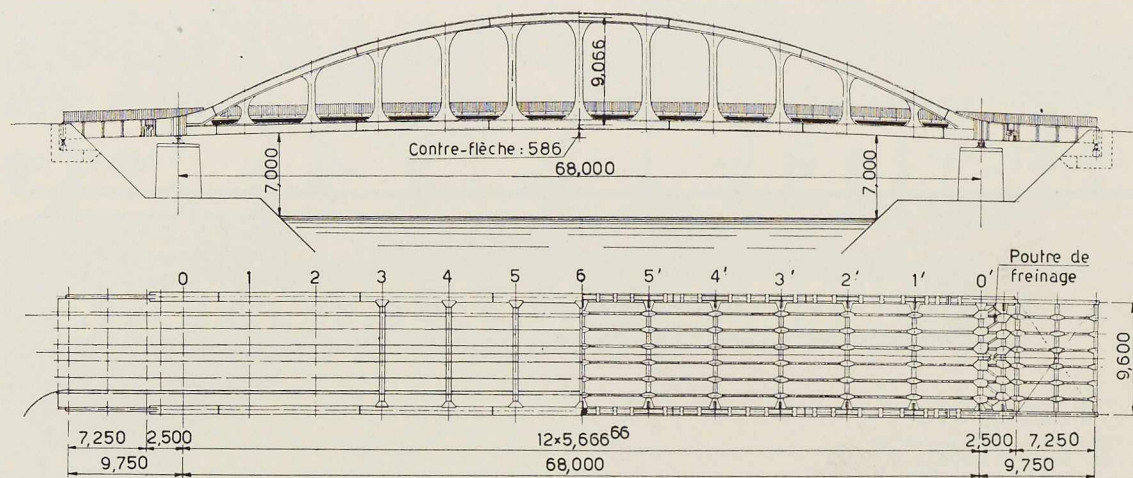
Elévation et vue en plan du nouveau pont de Lanaye.
